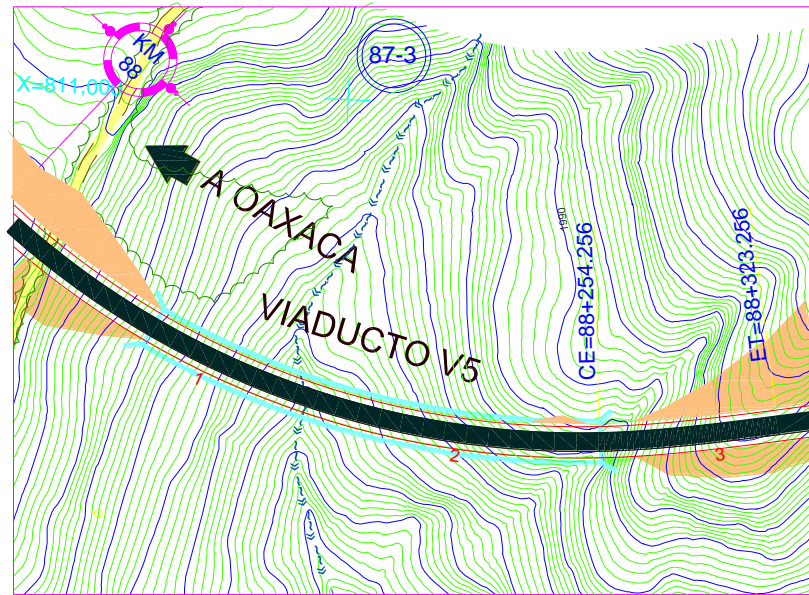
Planta del terraplén ubicado en el km 88+138 del Proyecto modificado.
